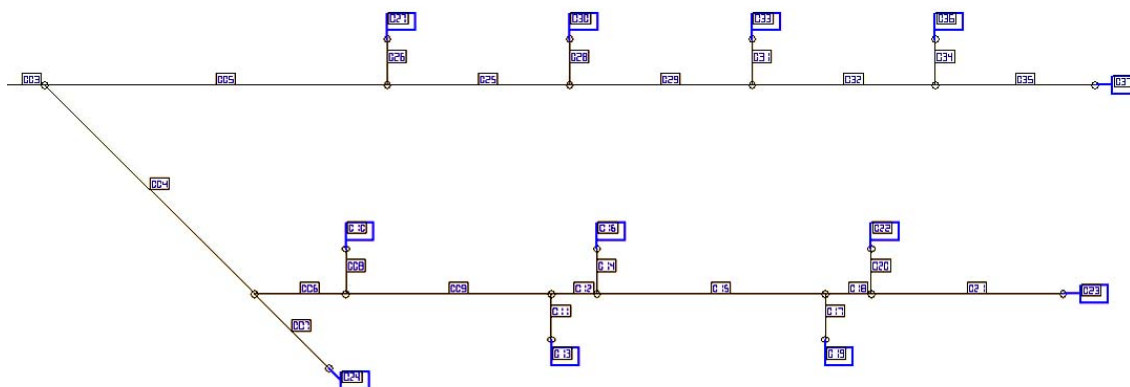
Esquema del circuit de refrigeració de la planta baixa
